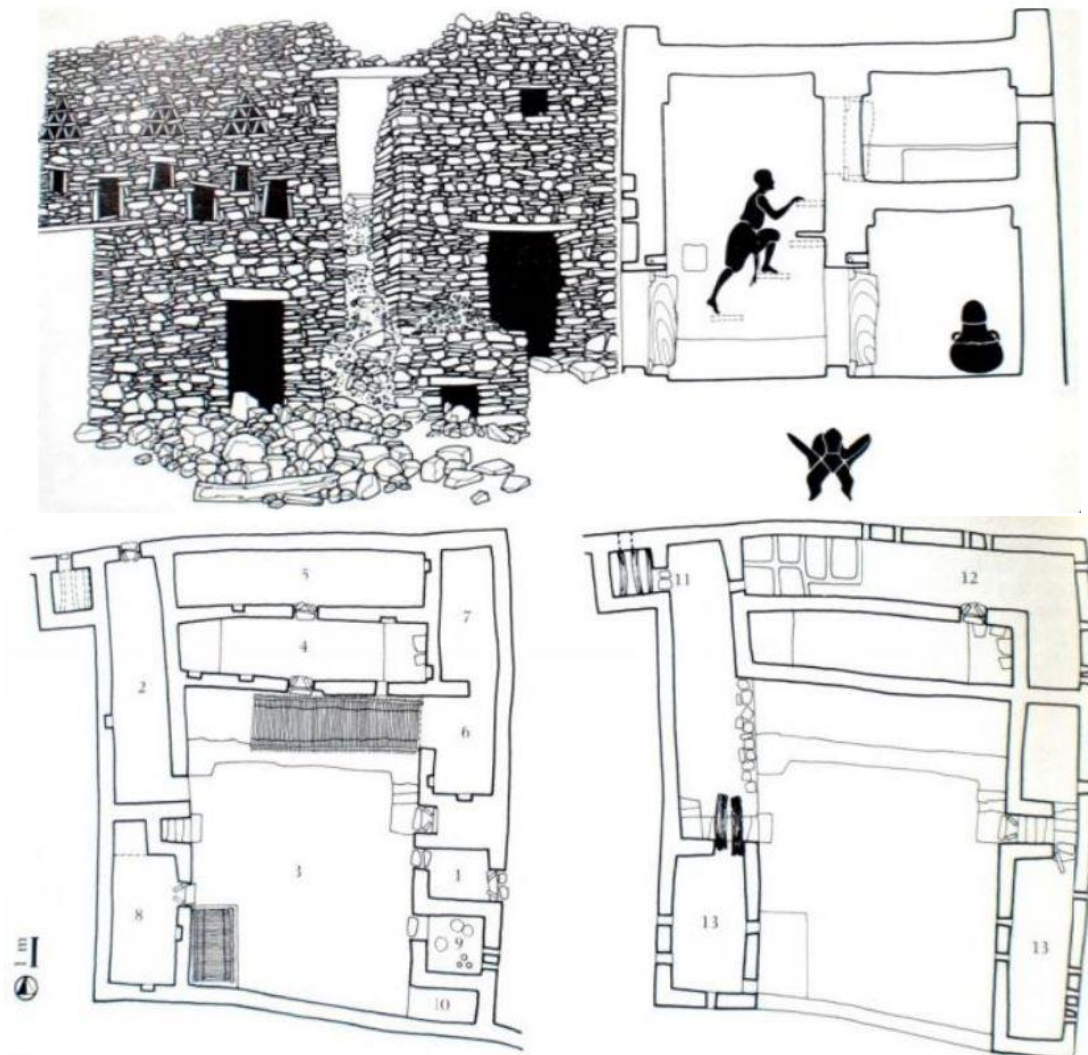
plantas y alzados tipos de una vivienda en ciudad caravanera.
